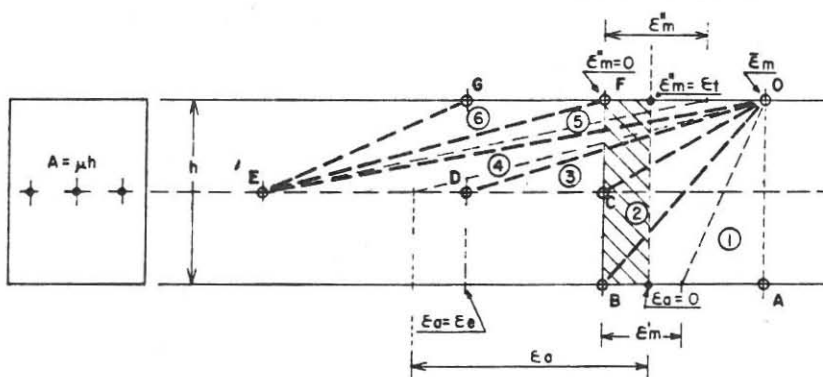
Schema geometrico della sezione mista di muratura ed acciaio e diagrammi di deformazione a rottura per armatura in posizione centrale.
